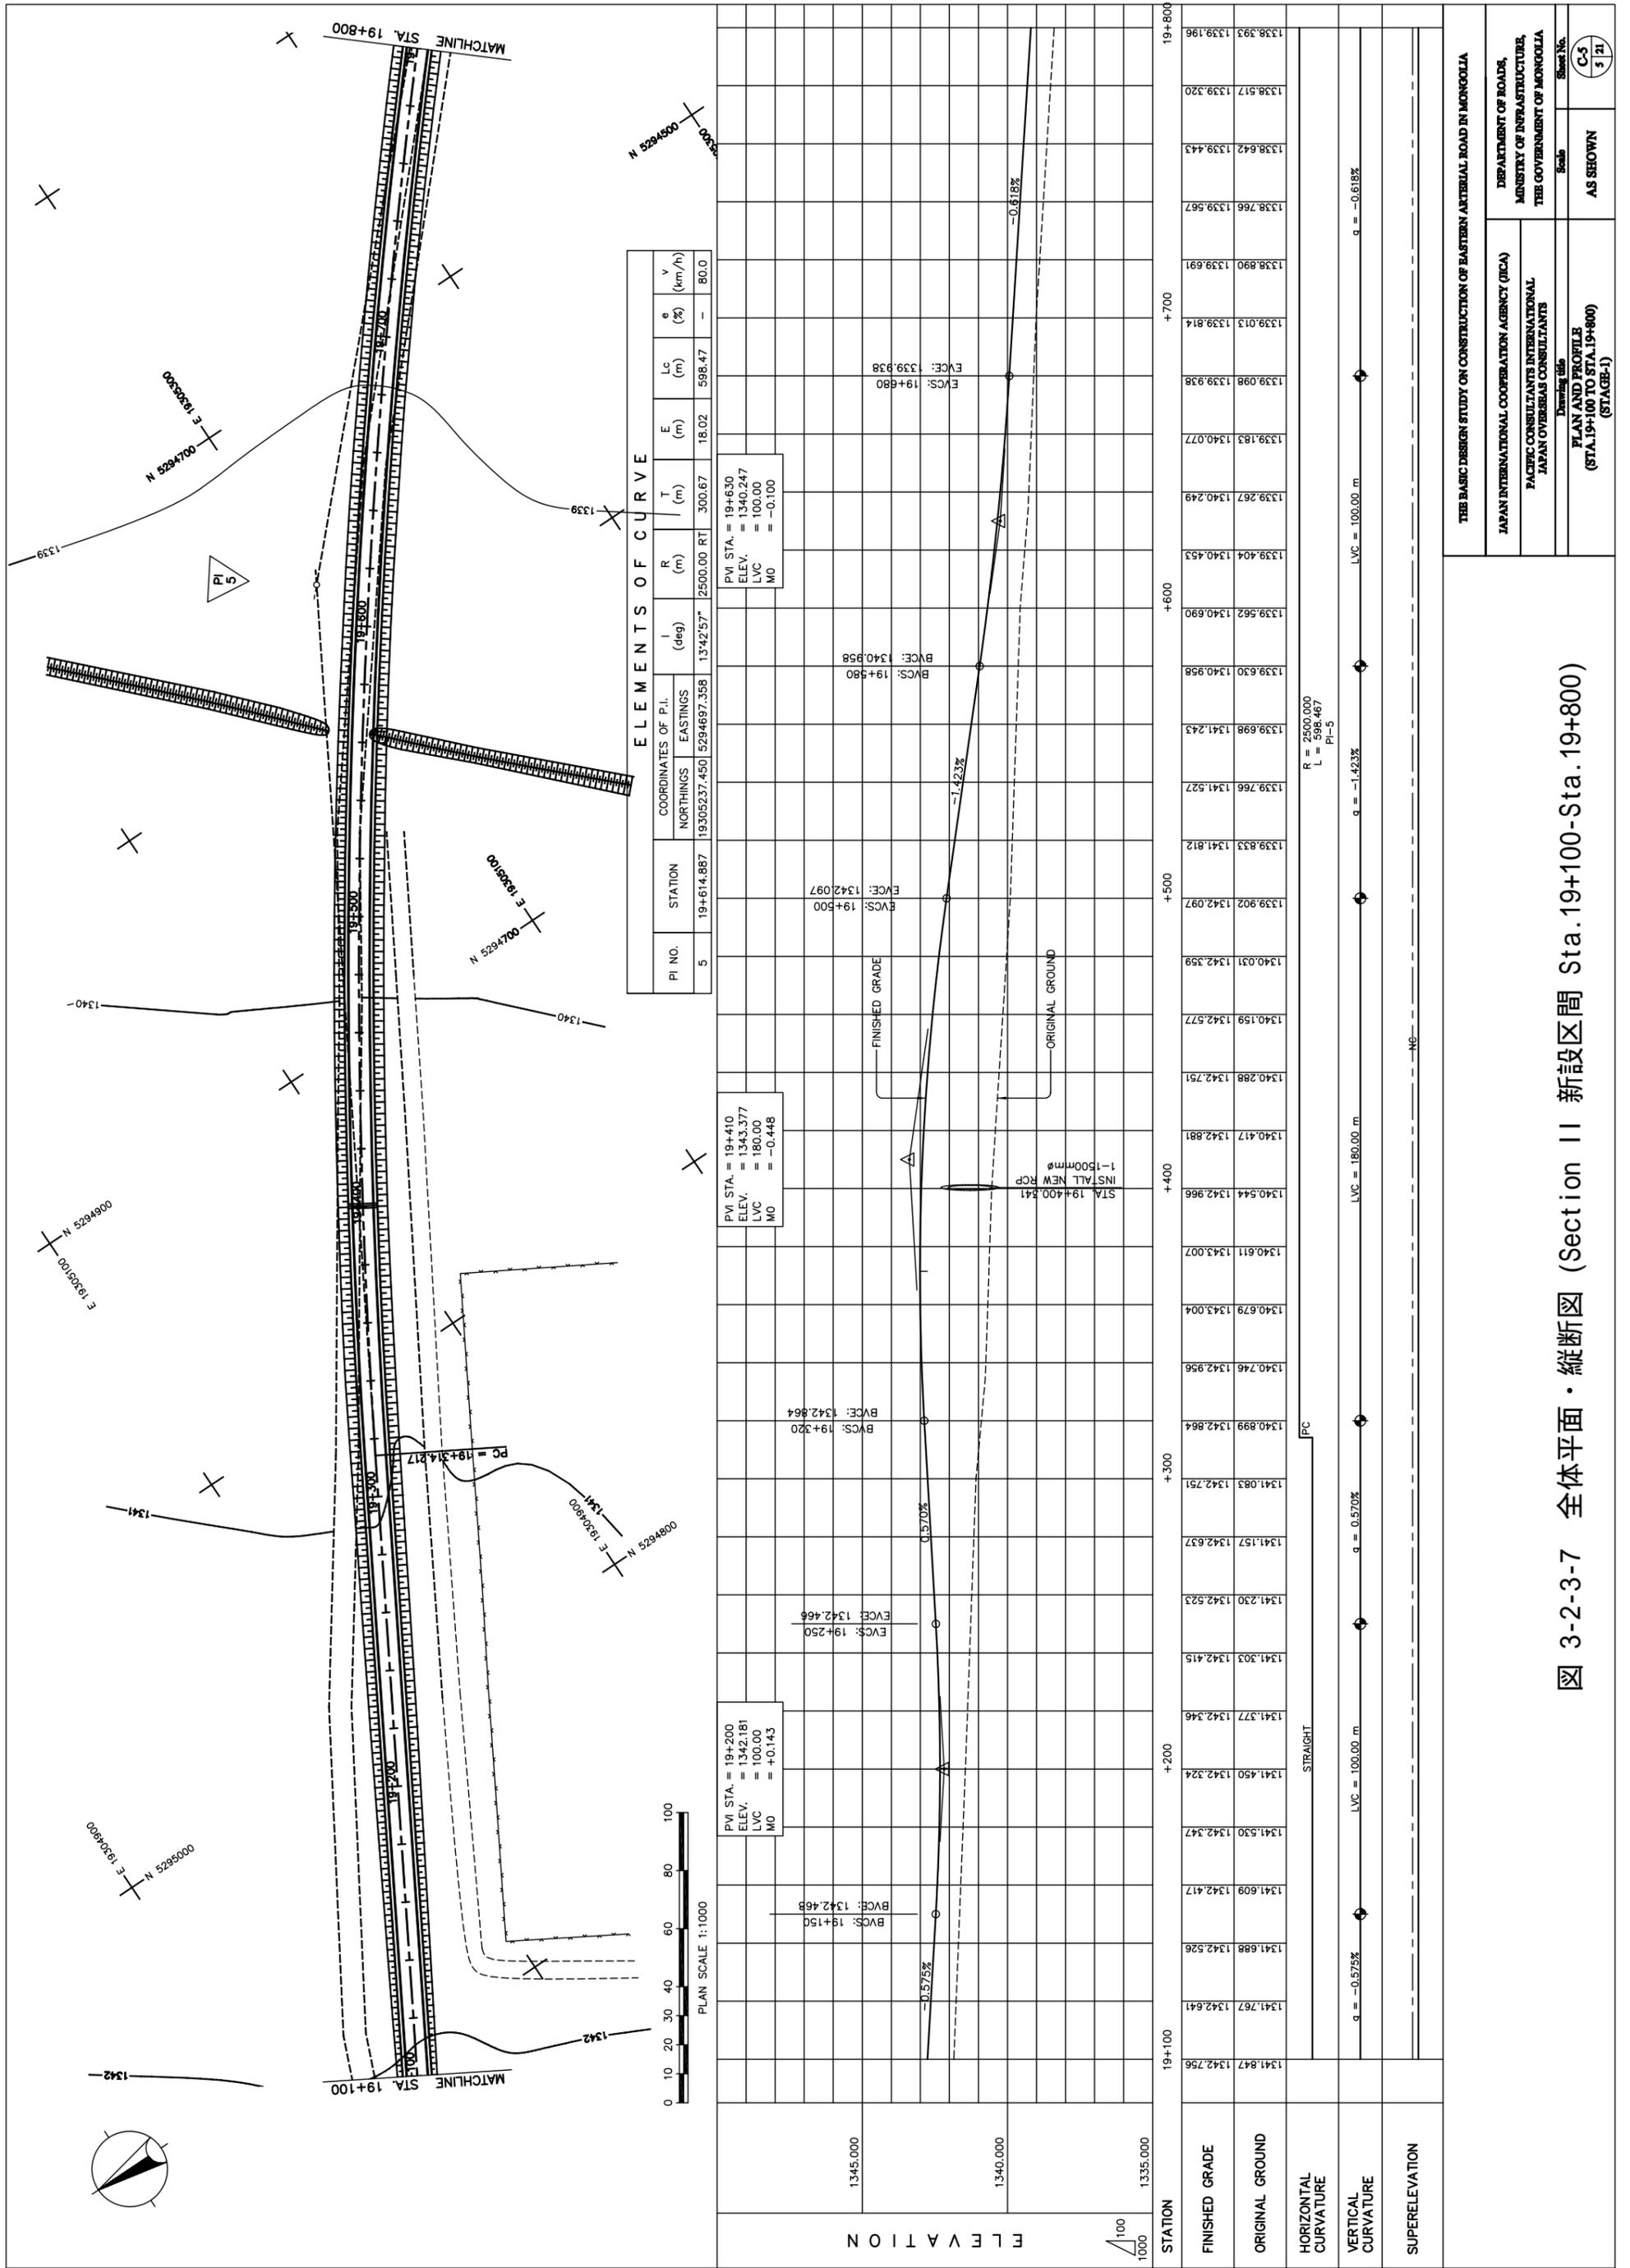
全体平面・縦断面 (Section II 新設区間 Sta.19+100-Sta.19+800)
